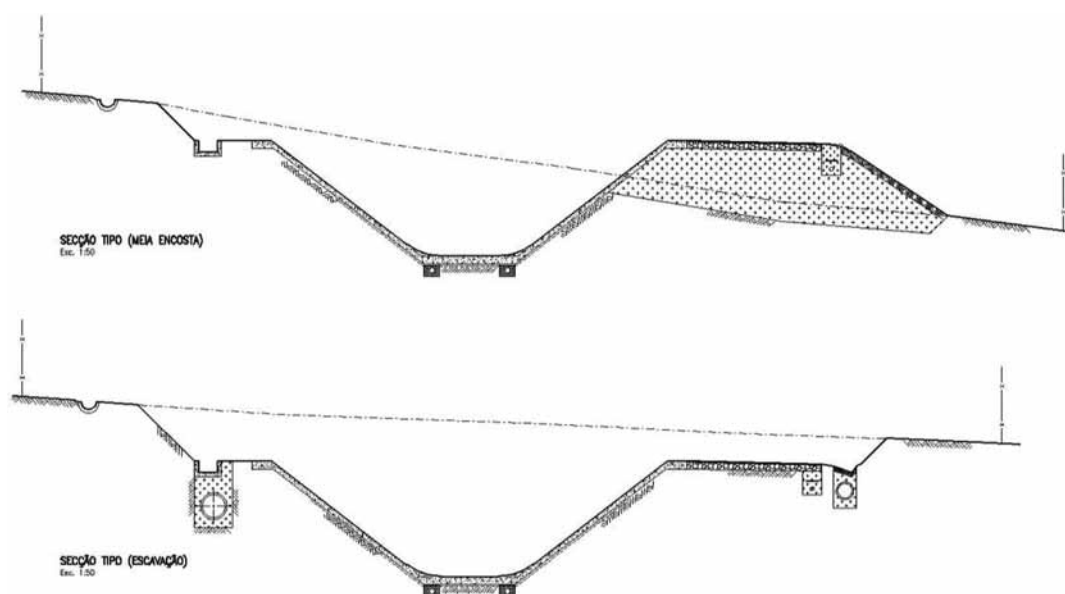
Perfis transversais tipo dos canais. Secção em escavação e a meia encosta.
